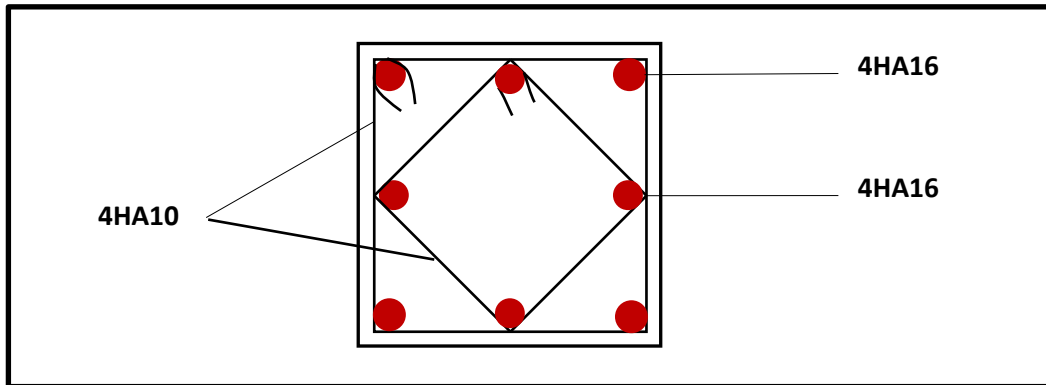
Schéma de ferrailage du poteau 45x45.
